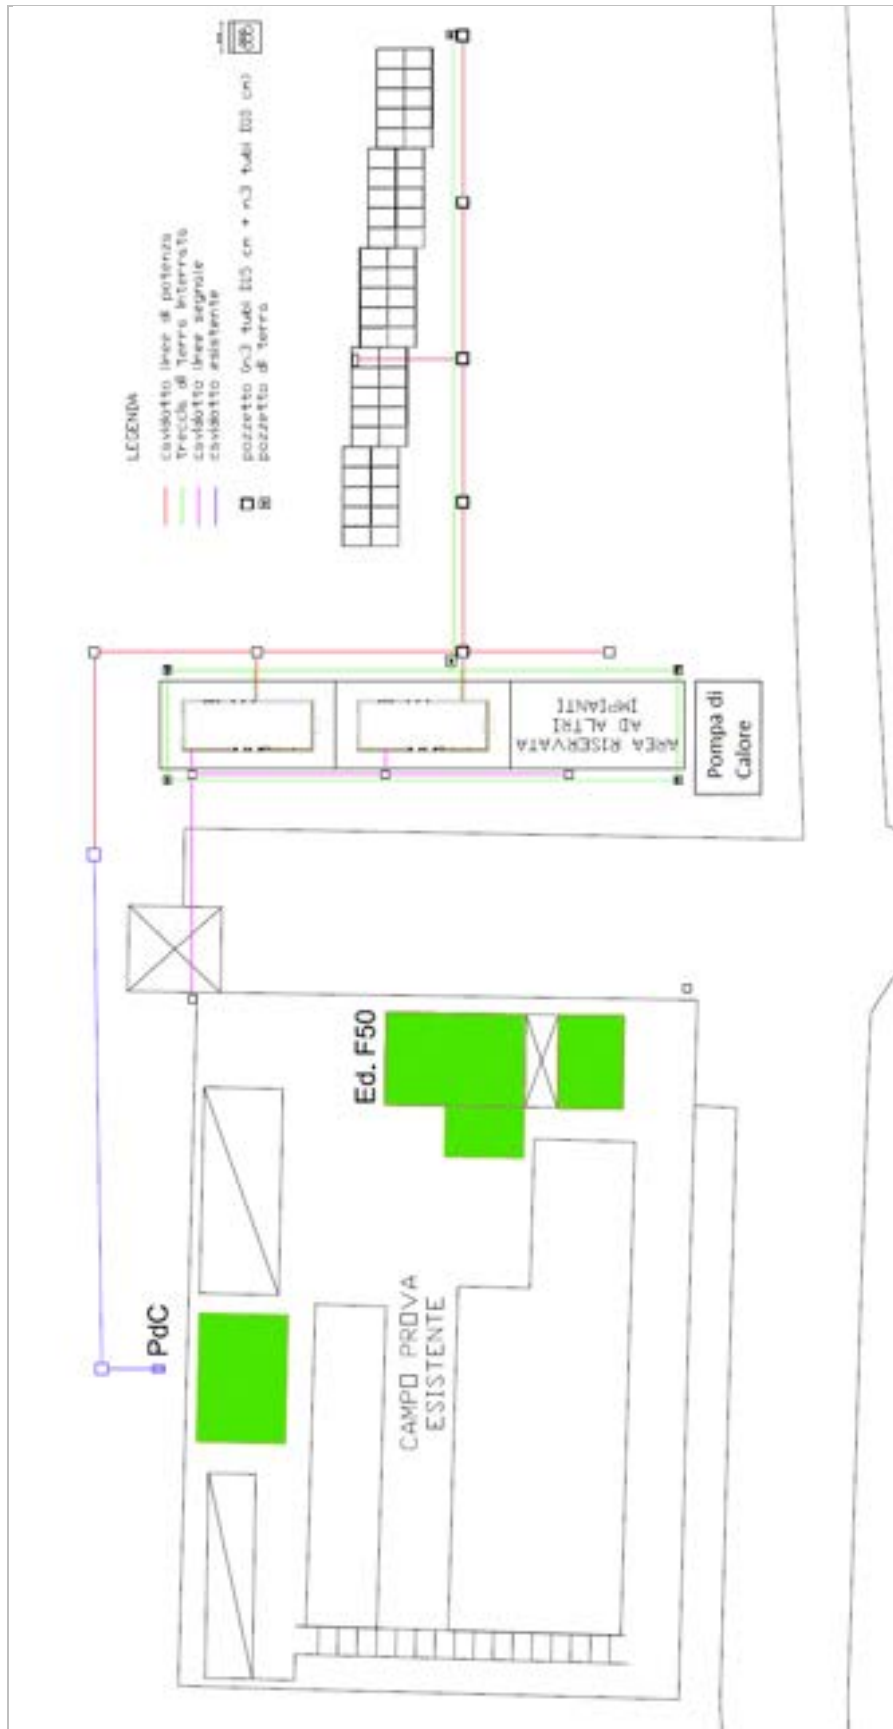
Planimetria del sito di installazione con l'ubicazione degli impianti
